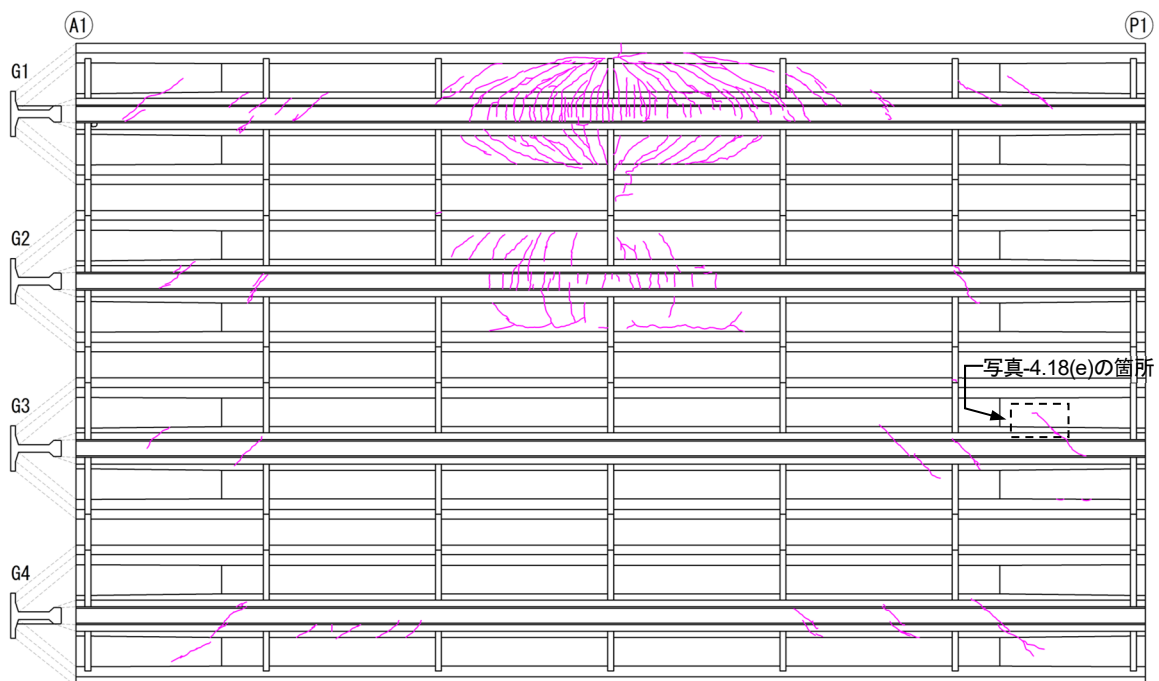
荷重試験時の各主桁のひび割れ状況
